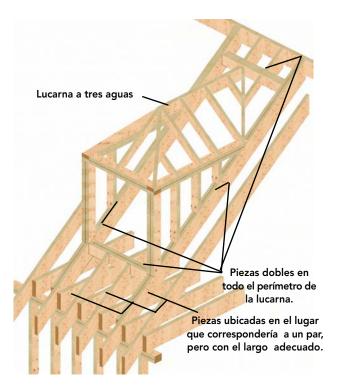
Lucarna a tres aguas que interrumpe los elementos estructurales del diafragma inclinado y que requiere de refuerzos en el perímetro donde se recortaron las piezas de la estructura de techumbre.
